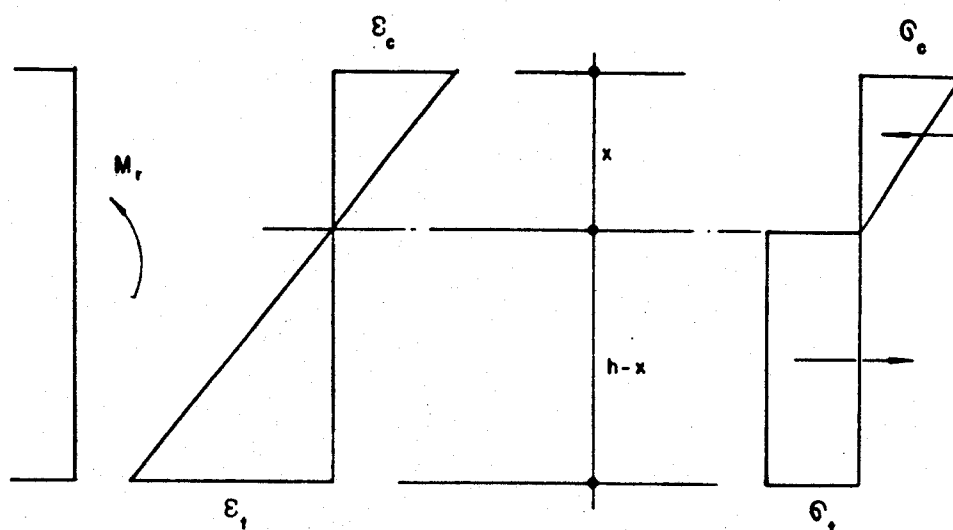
Formulação para cálculo do momento fletor de fissuração segundo a NBR 6118/80.
